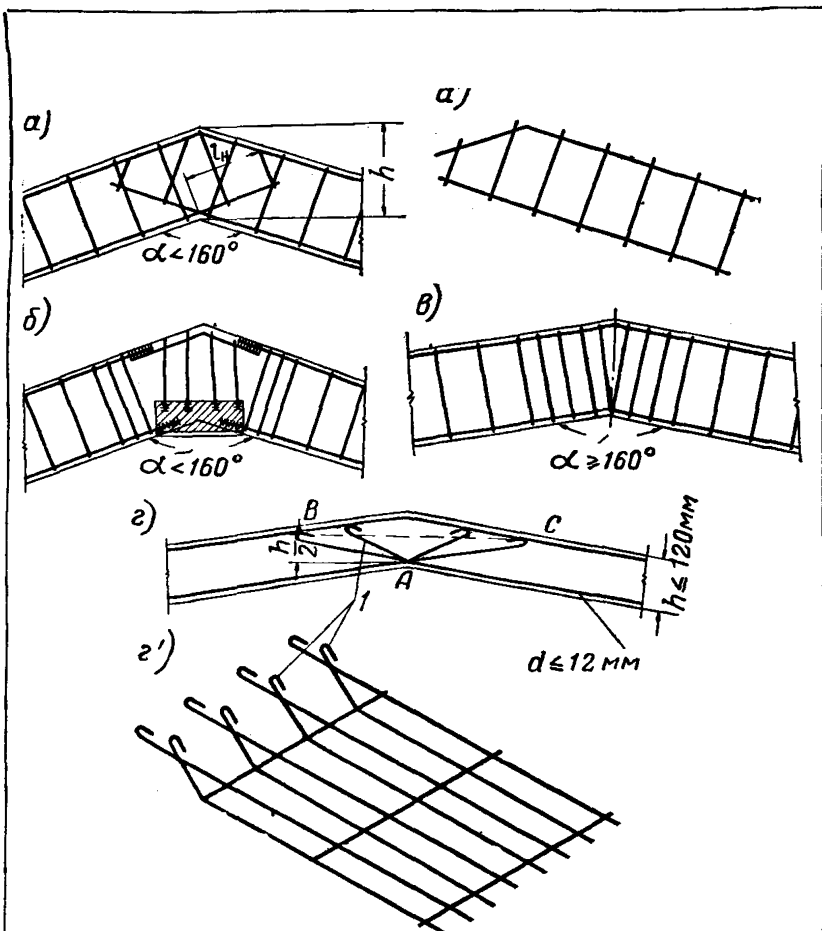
Армирование сварными каркасами и сетками входящих углов железобетонных элементов
